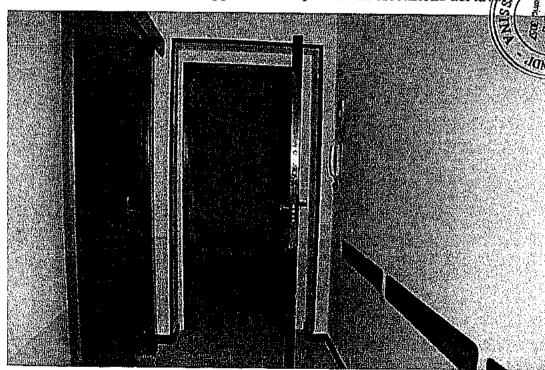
Condizioni dell'appartamento a lavori eseguiti
